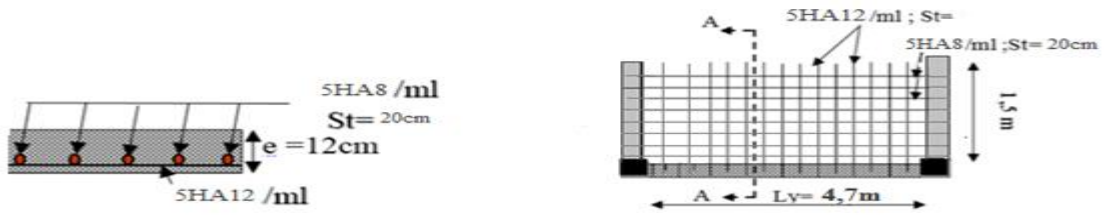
Schéma de ferrailage du panneau D2 dalle sur 2 appuis
